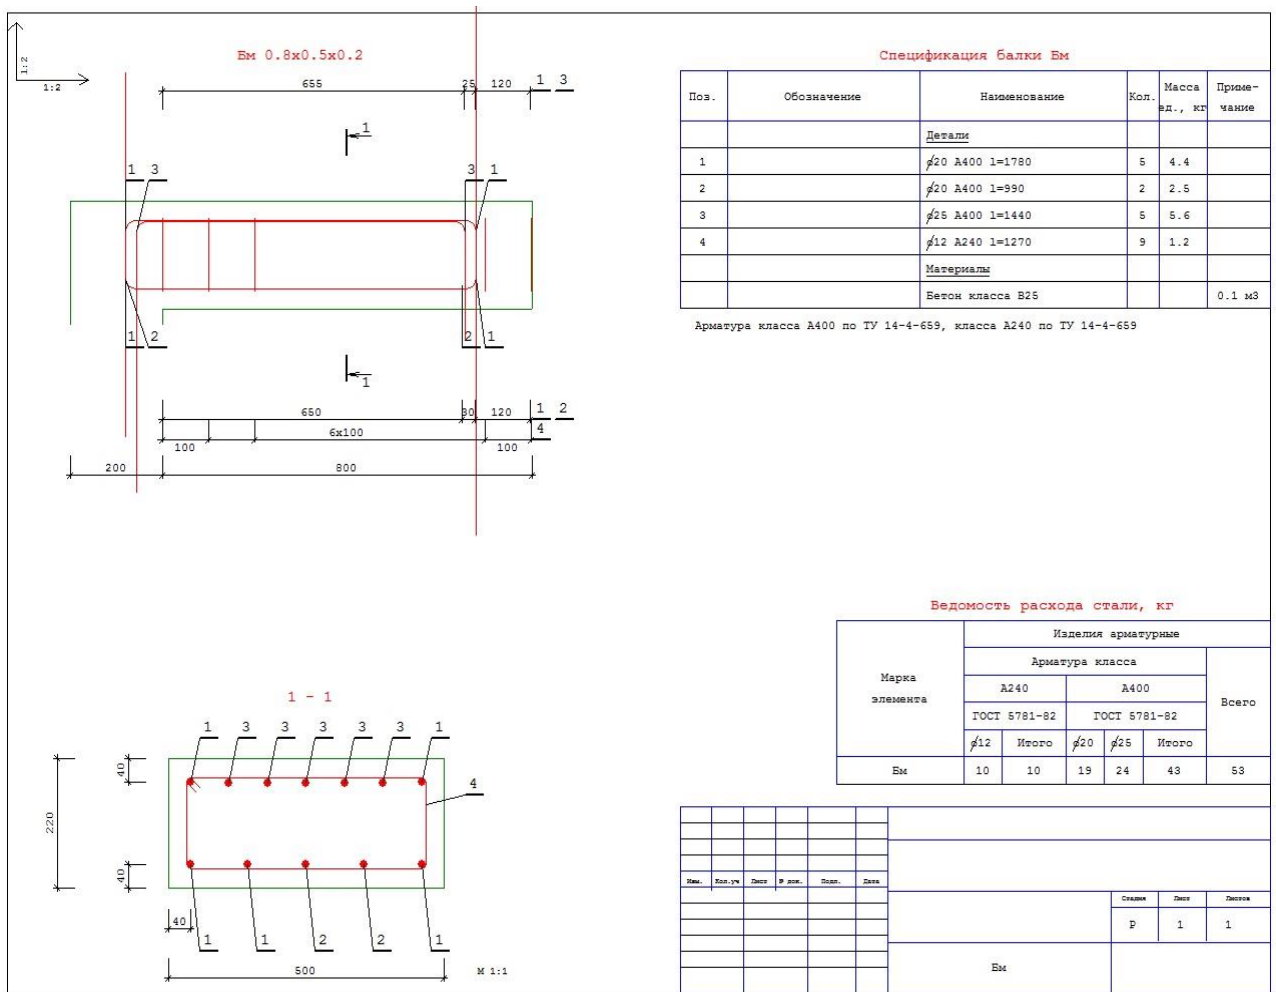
Армирование многопролётного ригеля на опоре первого пролёта
